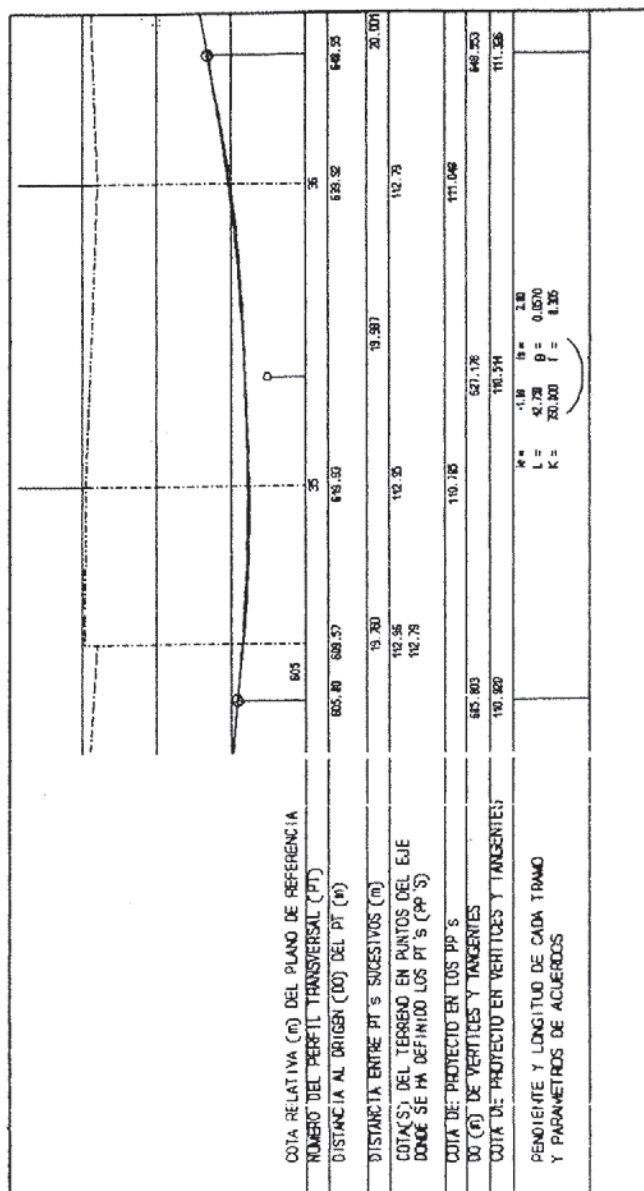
E Detalle Perfil Longitudinal (Viña del Mar)
